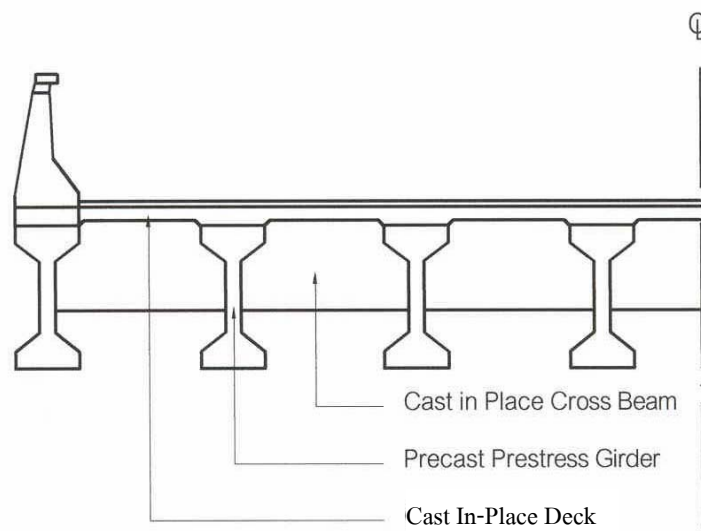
Superstructure ของ Girder Type Maximum Span 20.00 m
